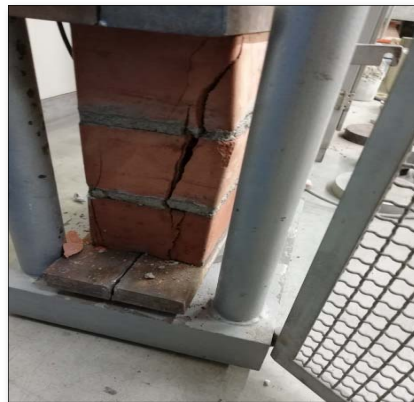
Ensayo de compresión muro con inmersión al agua
